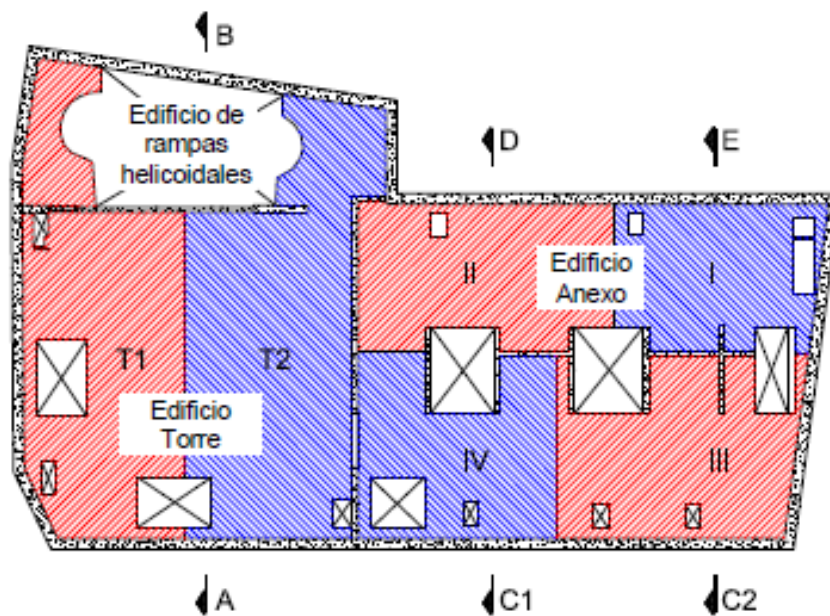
Secciones de procesos constructivos para el edificio Torre.
